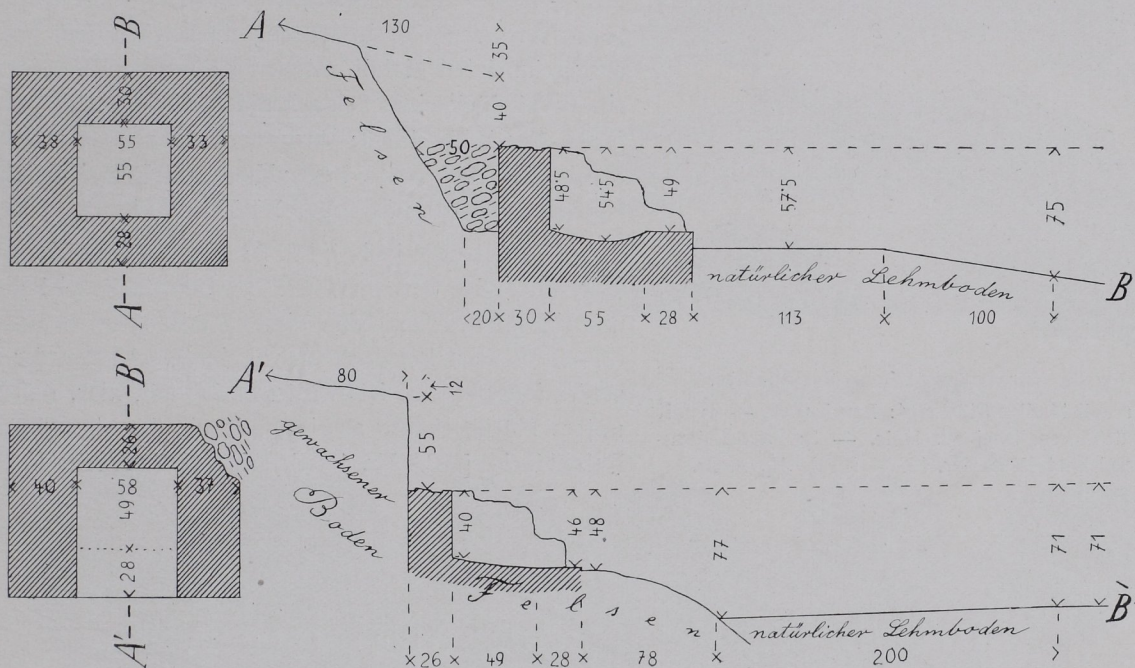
Grundrisse und Längsschnitte der Schmelzöfen: A—B von Fig. 36, A'—B' von Fig. 37. Maße in Zentimetern.
